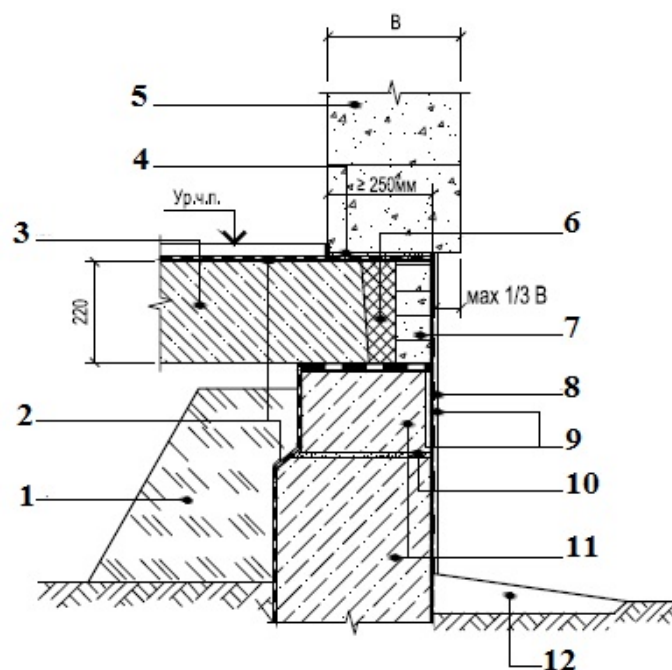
Устройство цоколя при железобетонном перекрытии: 1 — шлак, песок, газобетонный щебень; 2 — гидроизоляция; 3 — плита перекрытия; 4 — цементно-песчаный раствор; 5 — блоки YTONG; 6 — минеральный утеплитель или пенополистирол; 7 — кладка из полнотелого кирпича; 8 — штукатурка по сетке; 9 — гидроизоляция; 10 — раствор; 11 — бетонный блок; 12 — отмостка
